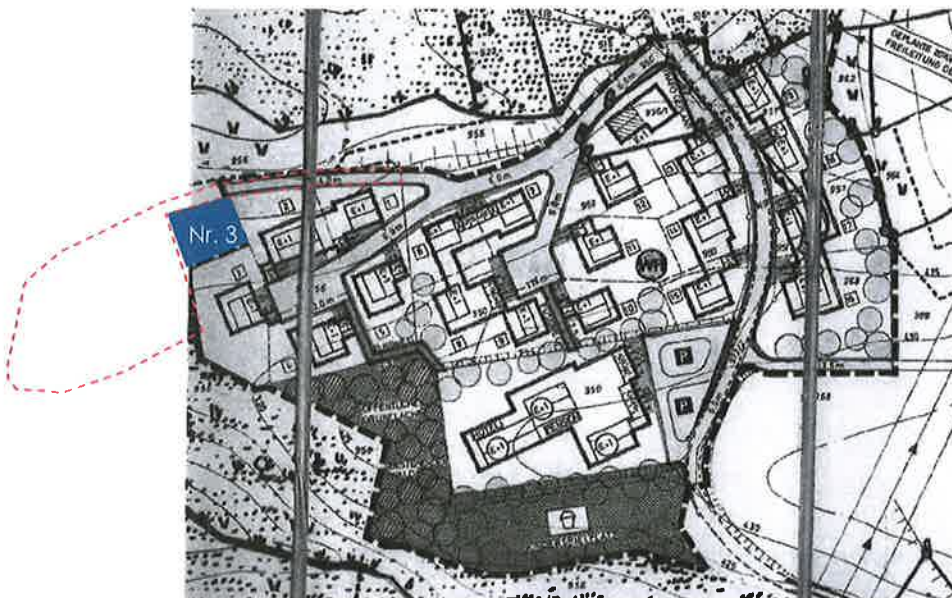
Ursprünglicher Bebauungsplan „Goldäcker“ mit Geltungsbereich vorliegender Deckblattänderung Nr. 3 (blau)
